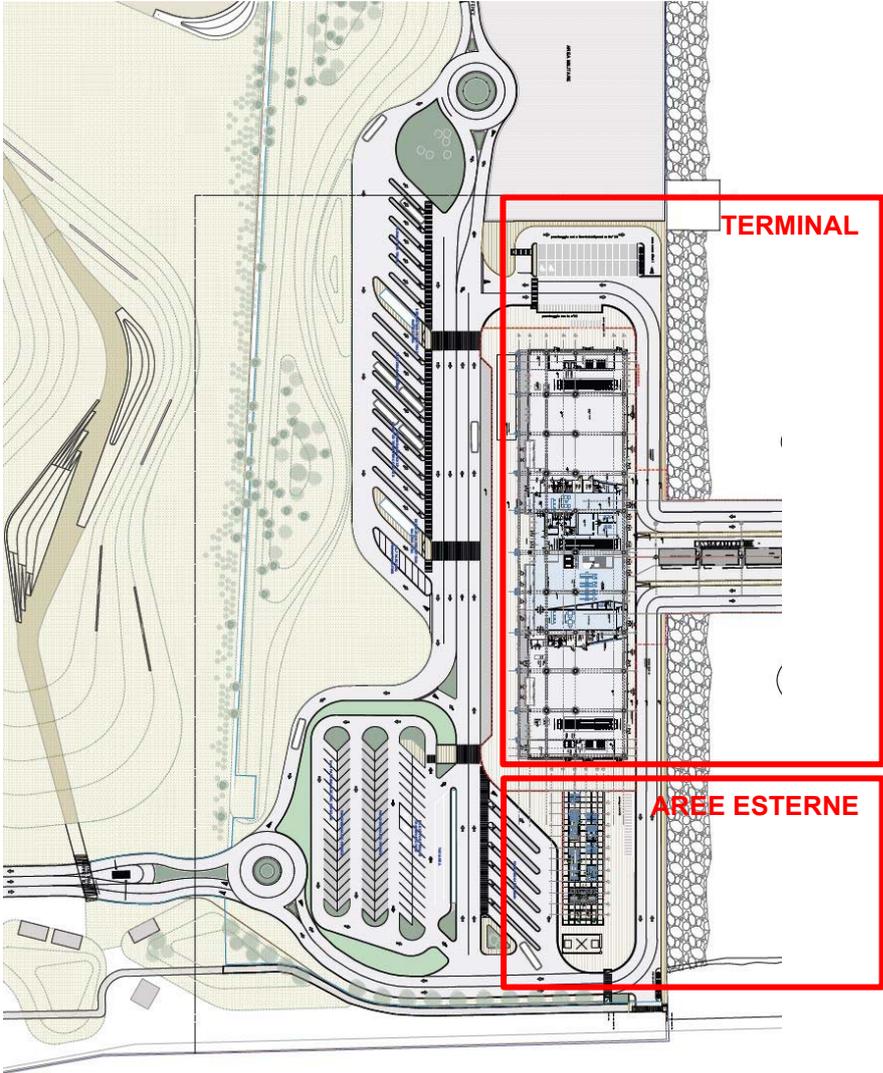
planimetria generale, Terminal ed aree esterne (lato Ovest)
